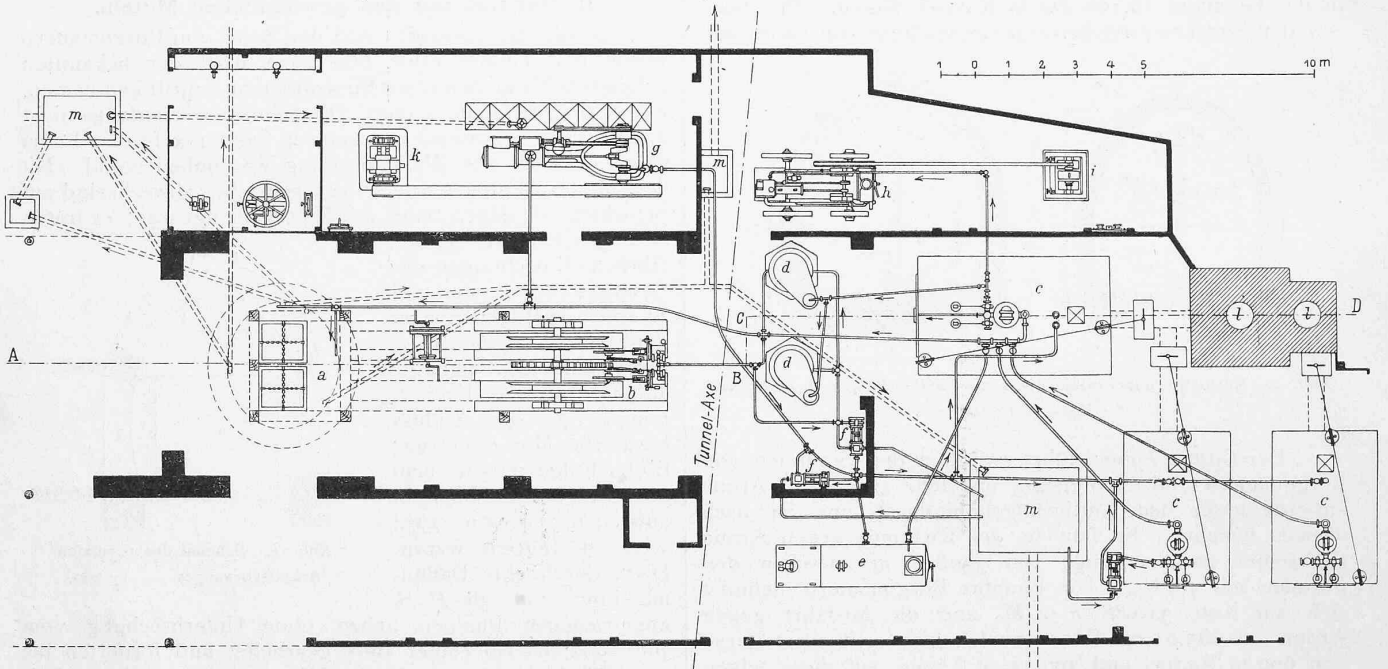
Lageplan der oberirdischen Installation im Schacht III. — Masstab 1 : 200.
